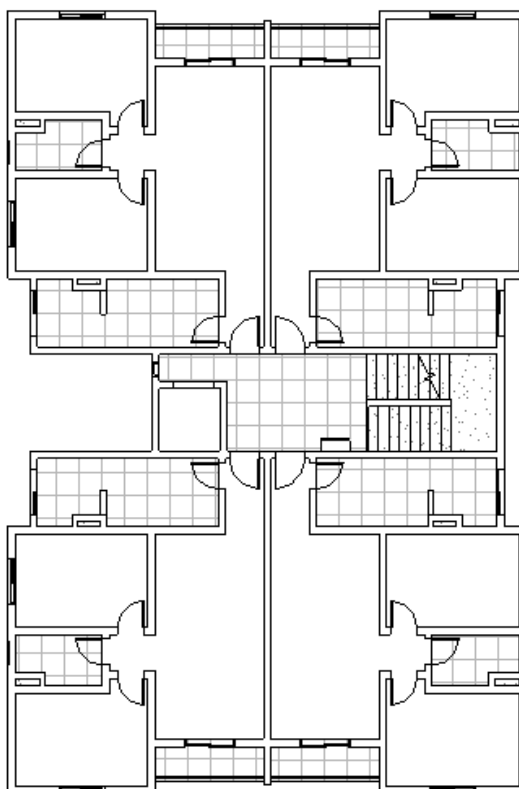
Planta do Pavimento tipo do Edifício em estudo – Fonte: REVIT
